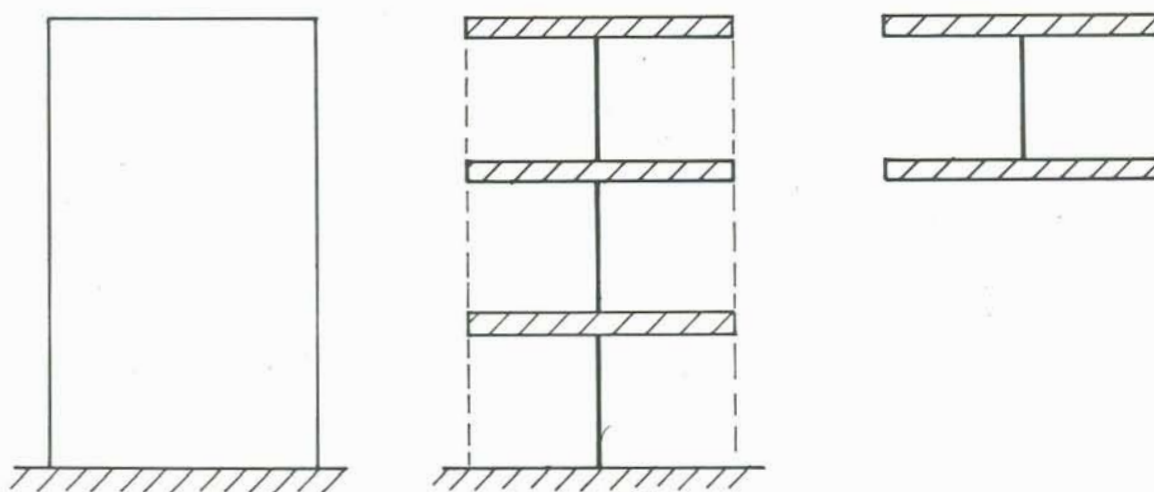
Parede com abertura utilizando elemento tipo "3"
